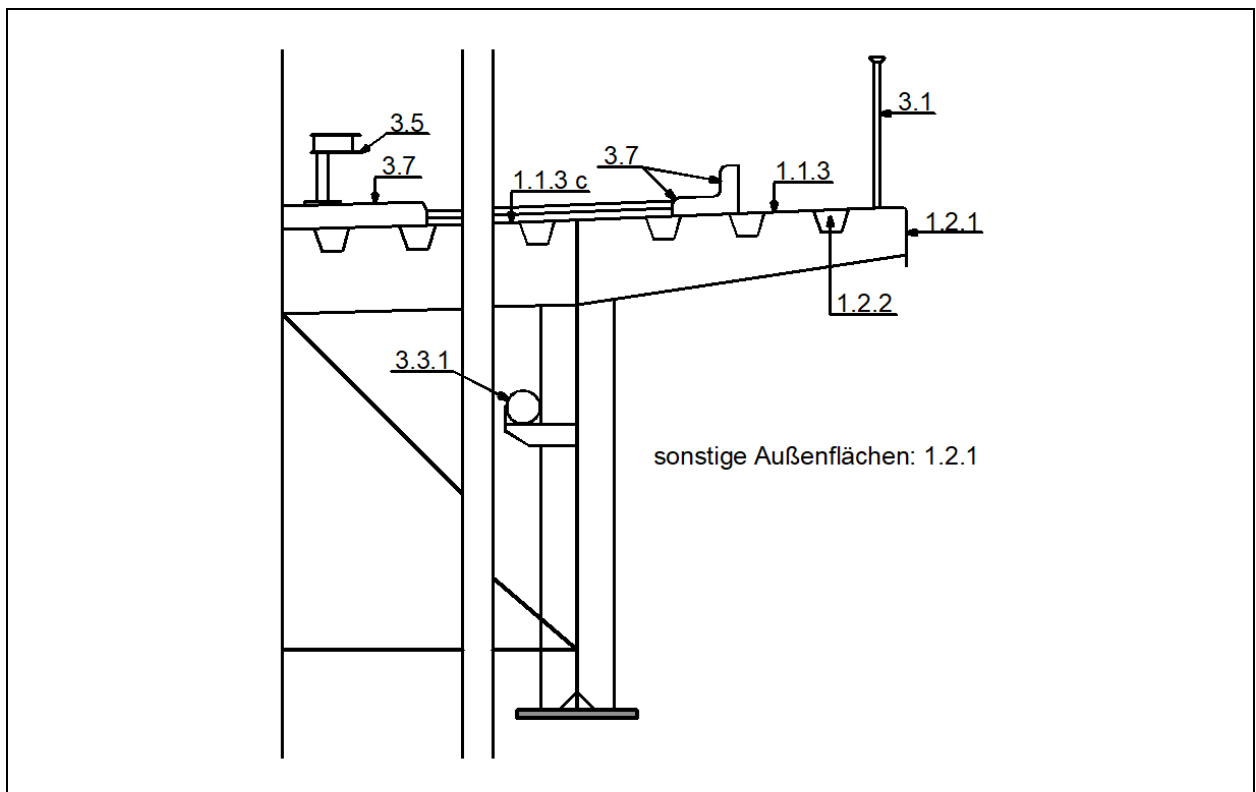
Teilquerschnitt einer Straßenbrücke mit offenem Querschnitt
